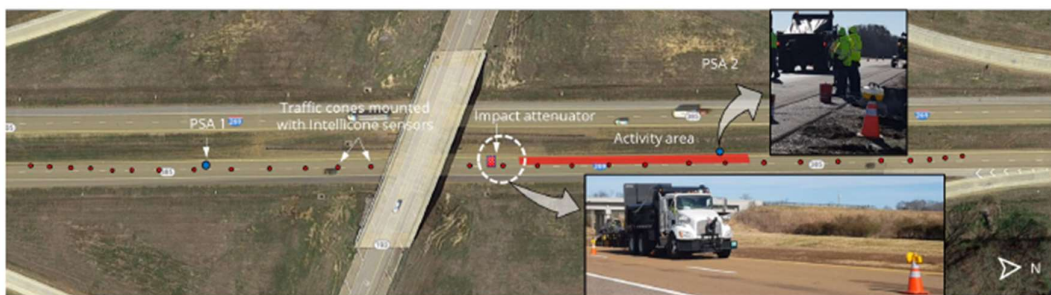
Installazione nell'area di cantiere del sistema Intellicone_ Seconda configurazione di cantiere
